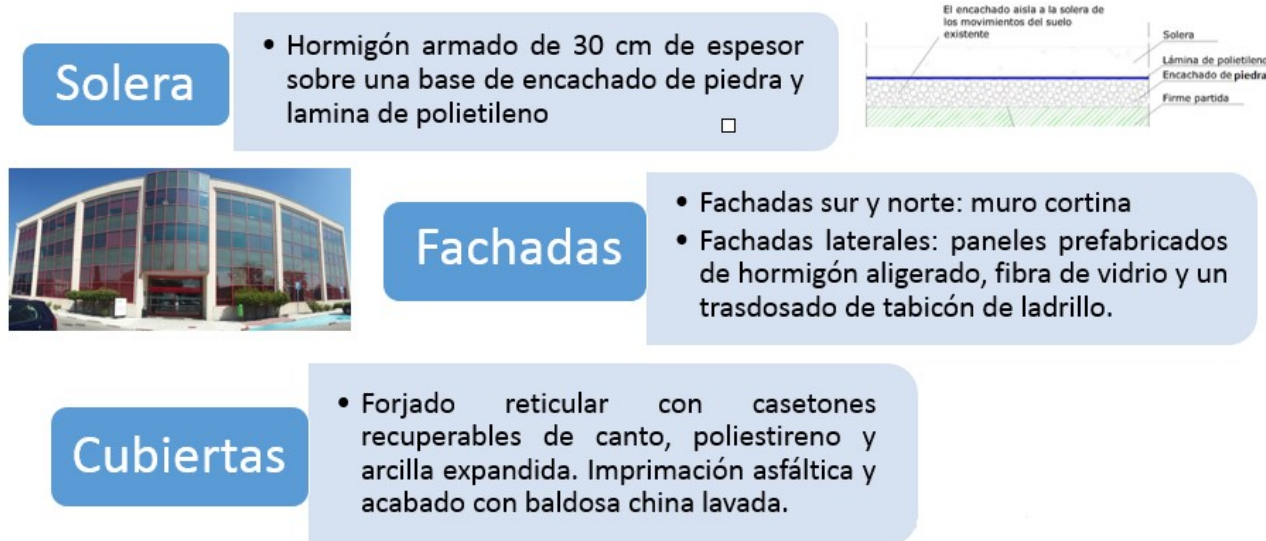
Características Constructivas de la Envolvente. Fuente: Planos constructivos del Edificio de Servicios
